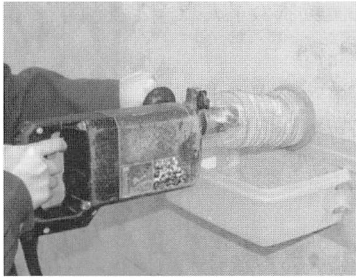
ドリルによるコンクリート粉末の採取¹²⁾
